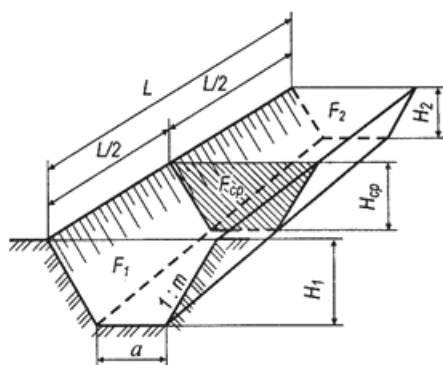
Схема для подсчета объемов земляных работ по разработке канавы
